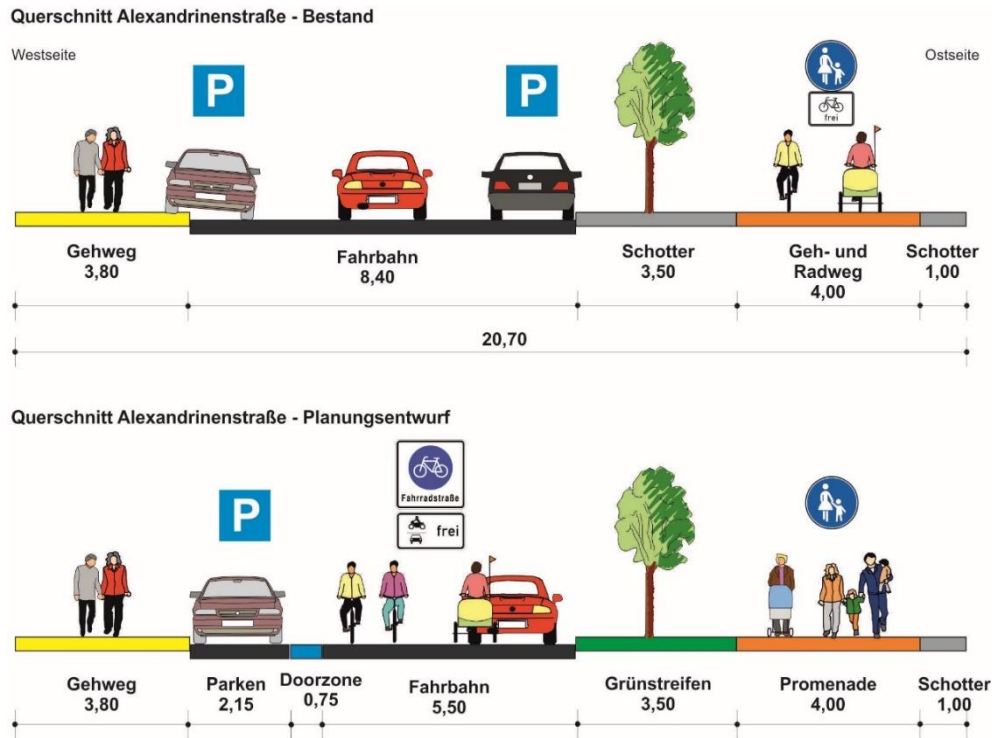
Bestandssituation und Planungsentwurf Alexandrinenstraße
